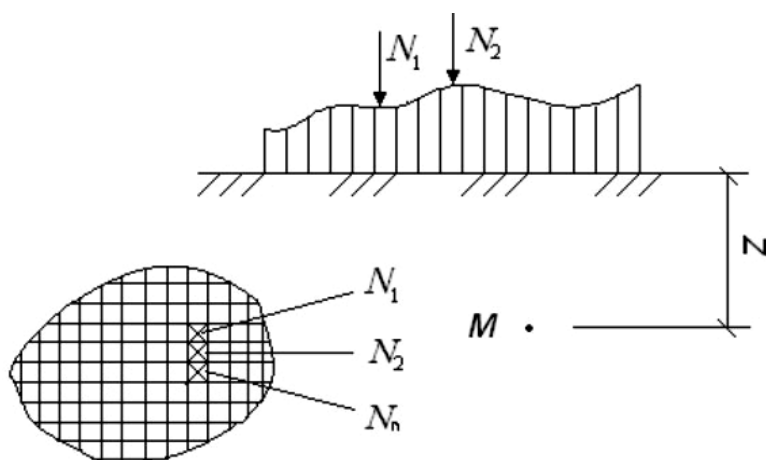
Схема к определению напряжений в массиве грунта при действии любой распределенной нагрузки
